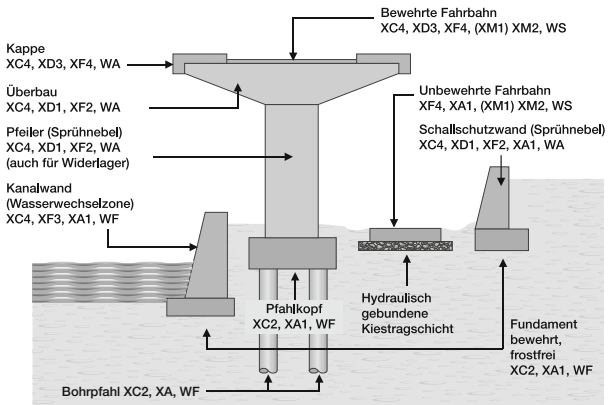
c: Betonbauteile im Ingenieurbau
